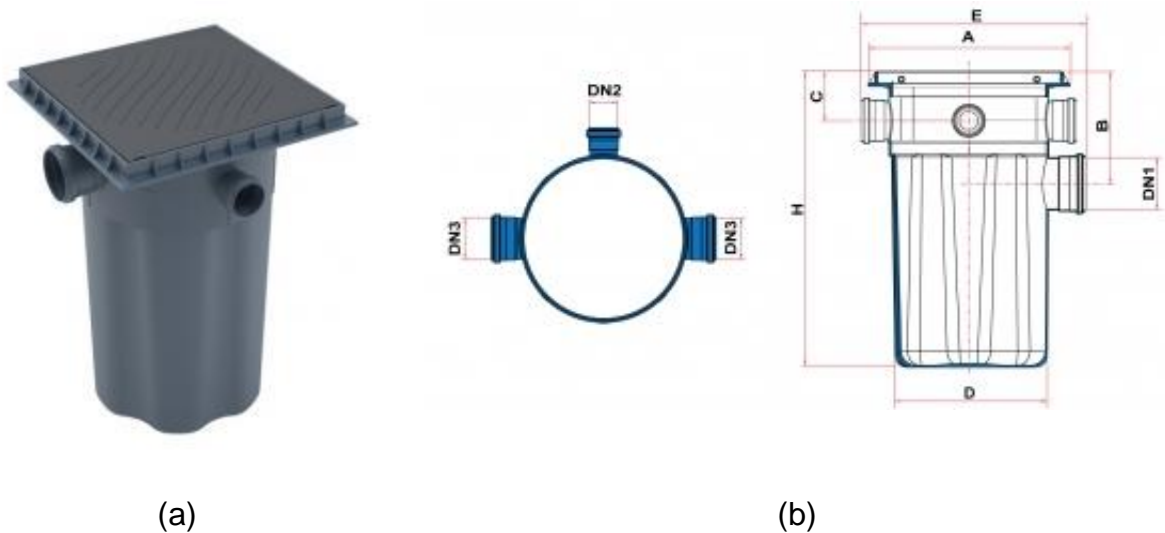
Caixa de gordura cilíndrica C1: a) foto; b) planta e corte esquemáticos.
